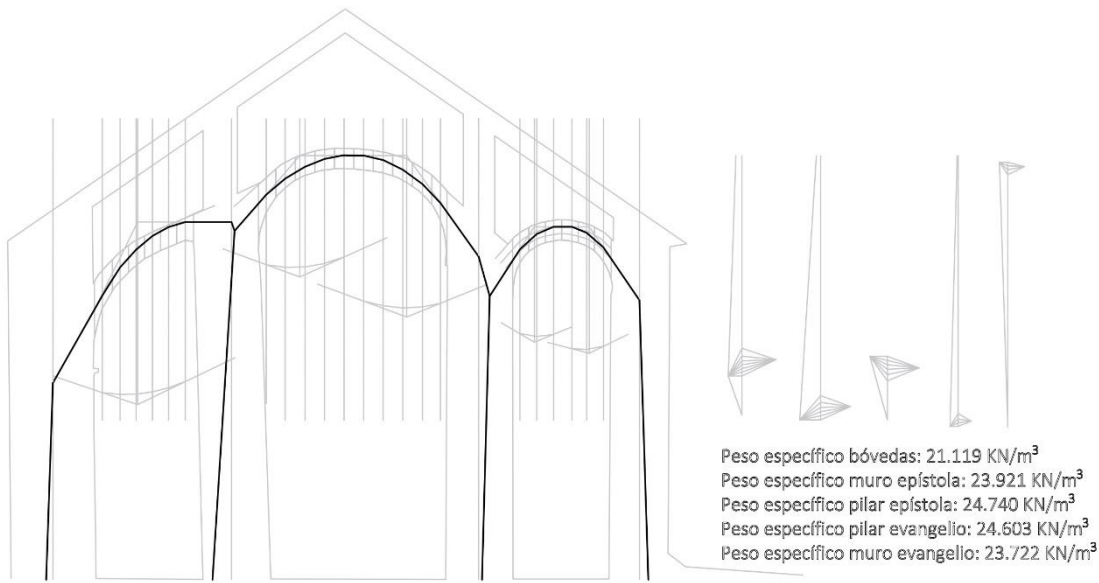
Estudio de la sección transversal por los pilares P5-P6 de Santa Maria de Vilamós.
